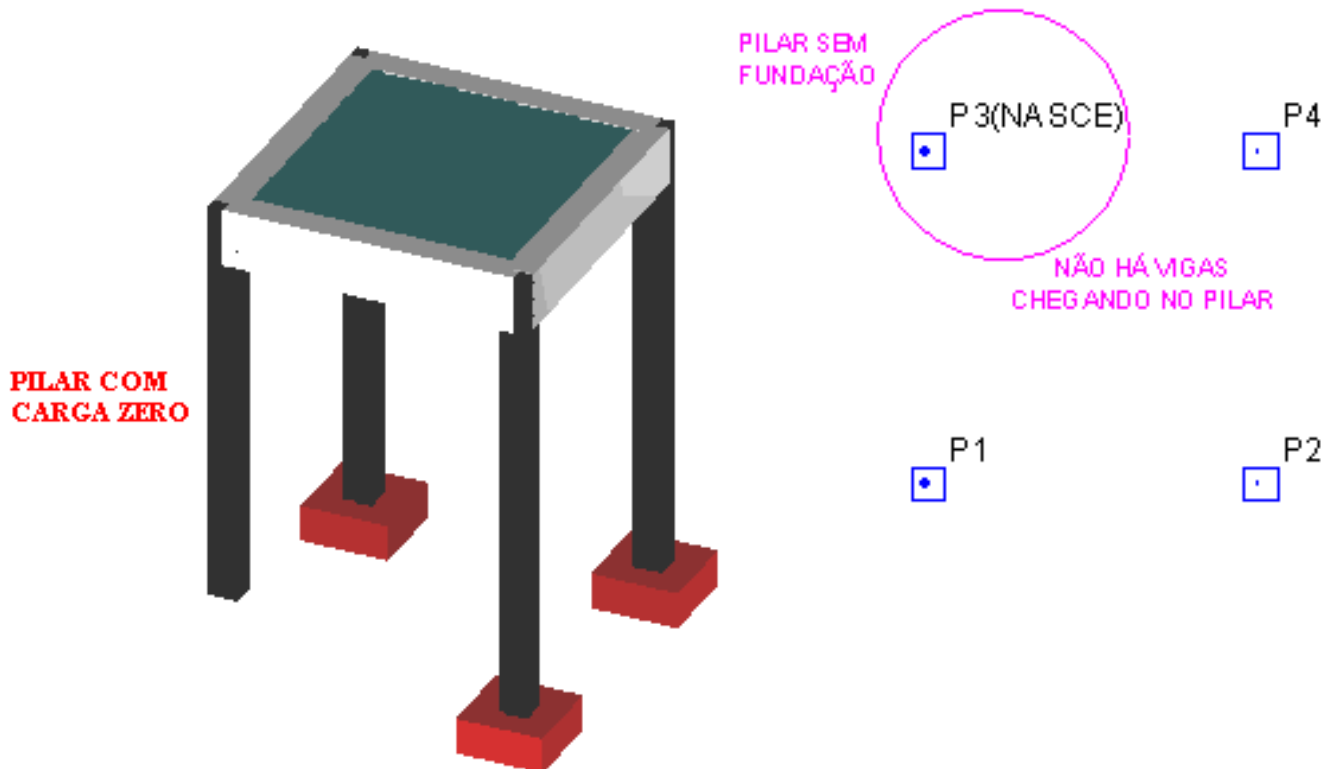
Pilar com carga zero: visualização no Pórtico 3D e no croqui do pavimento inferior
